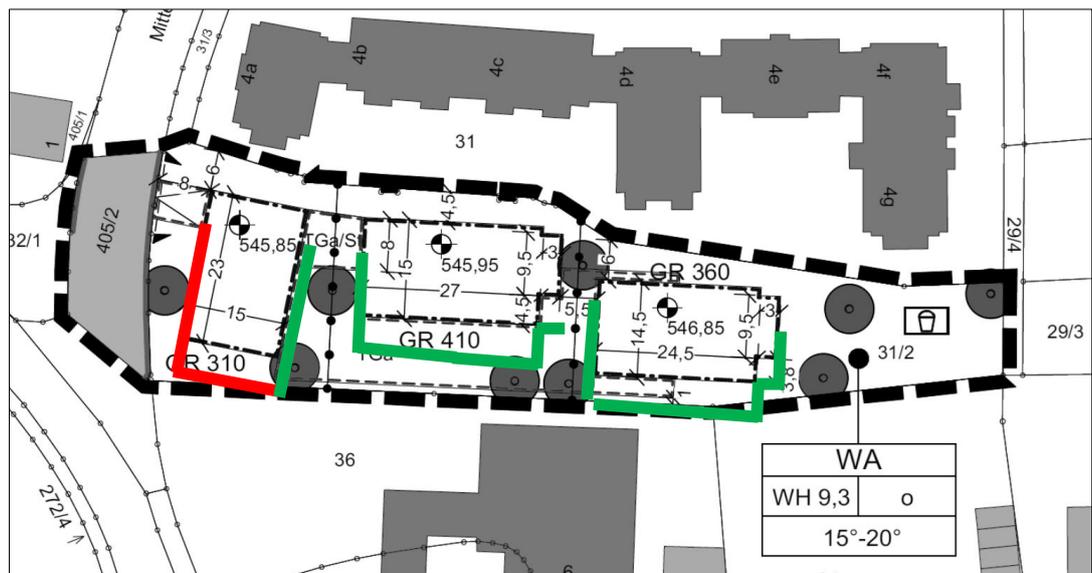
Fassadenkennzeichnung für die Vorschläge für Festsetzungen zum Bebauungsplan.
